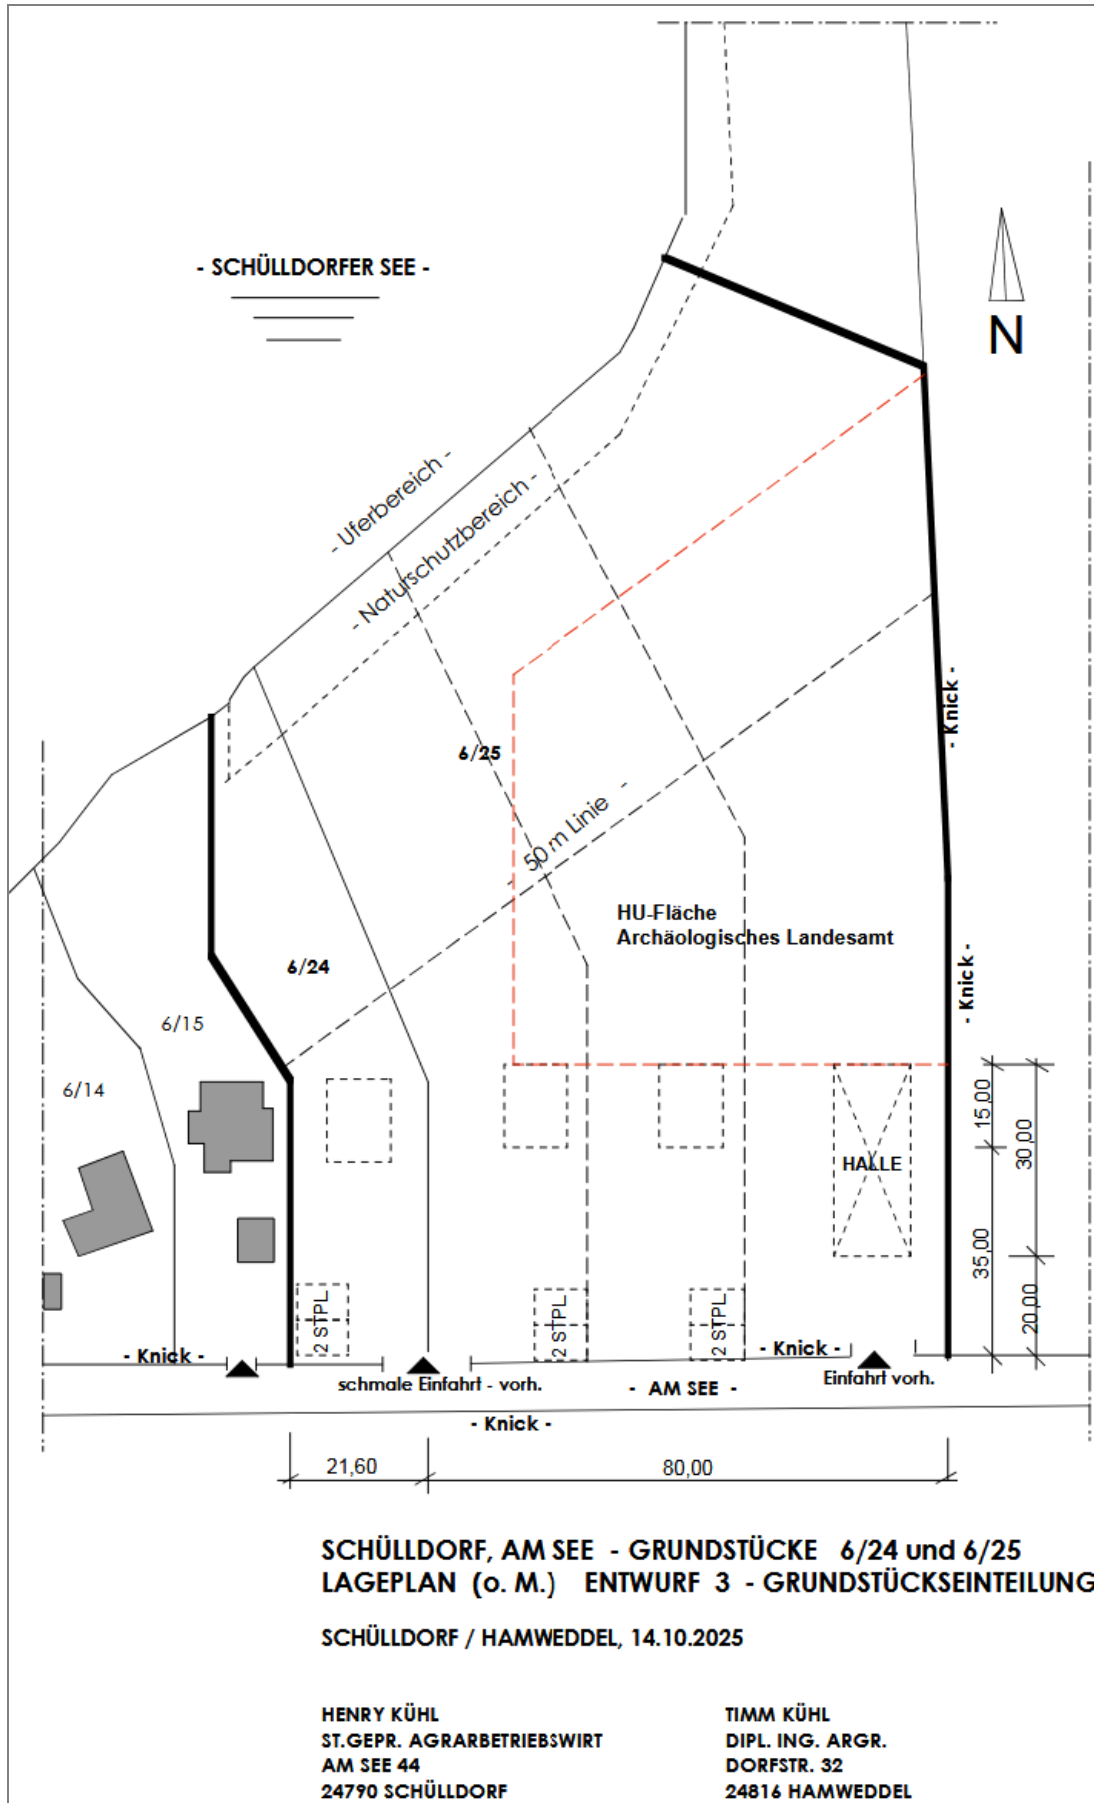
Lageplan und geplante Grundstückseinteilung, 3. Entwurf, Planstand 14.10.2025 (KÜHL 2025, ohne Maßstab)
